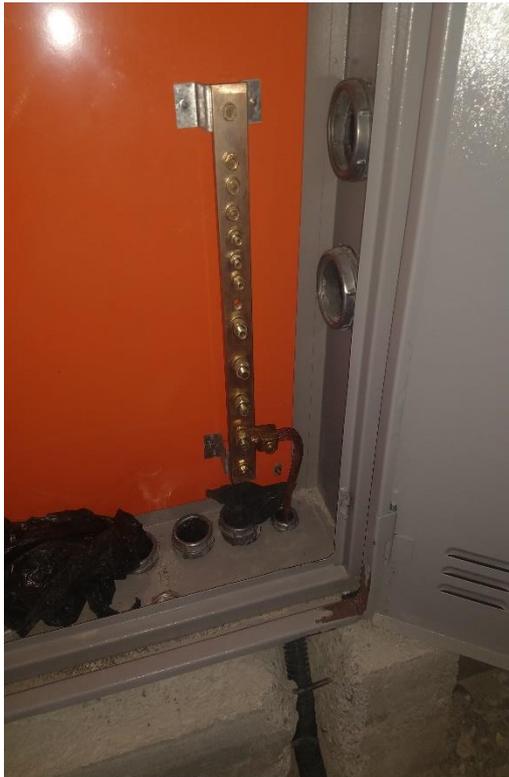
A 8: DETALHE DA EXECUÇÃO DO ATERRAMENTO SITUADO NO ESTACIONAMENTO.
